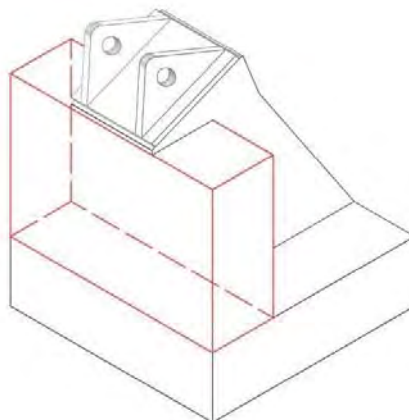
Muro adosado en la cimentación. Al integrar este muro al sistema de cimentación (*color rojo*), se creara un contrapeso ante las fuerzas de empuje de los arcos que pueden producir un volteo. Dibujo del autor.
